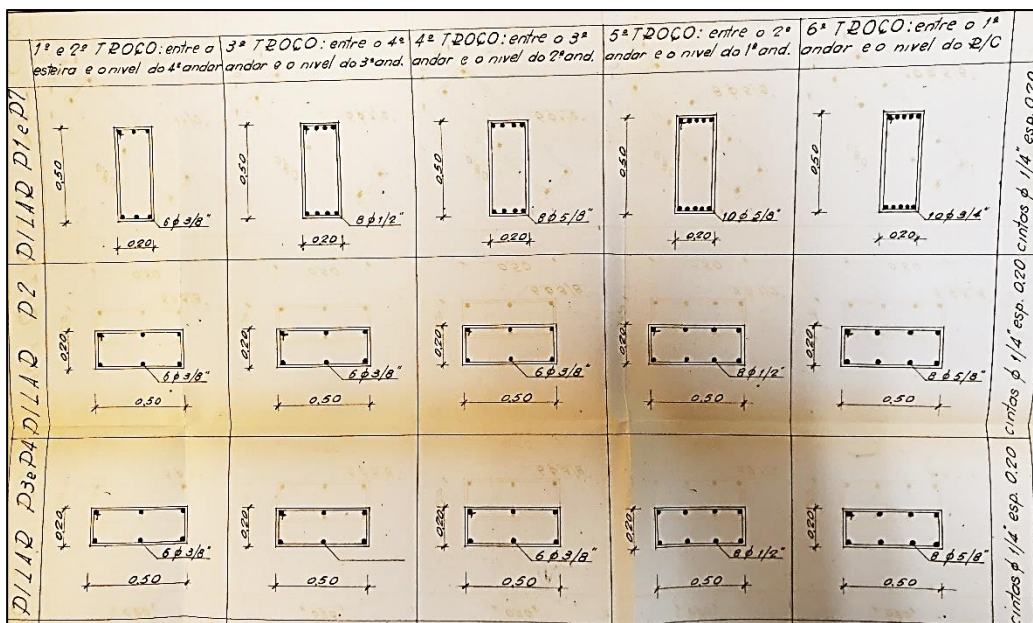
Projeto de estruturas do edifício tipo (1/2)
